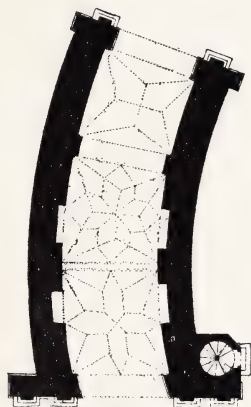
Grundriss des Ooster Thores zu Hoorn
